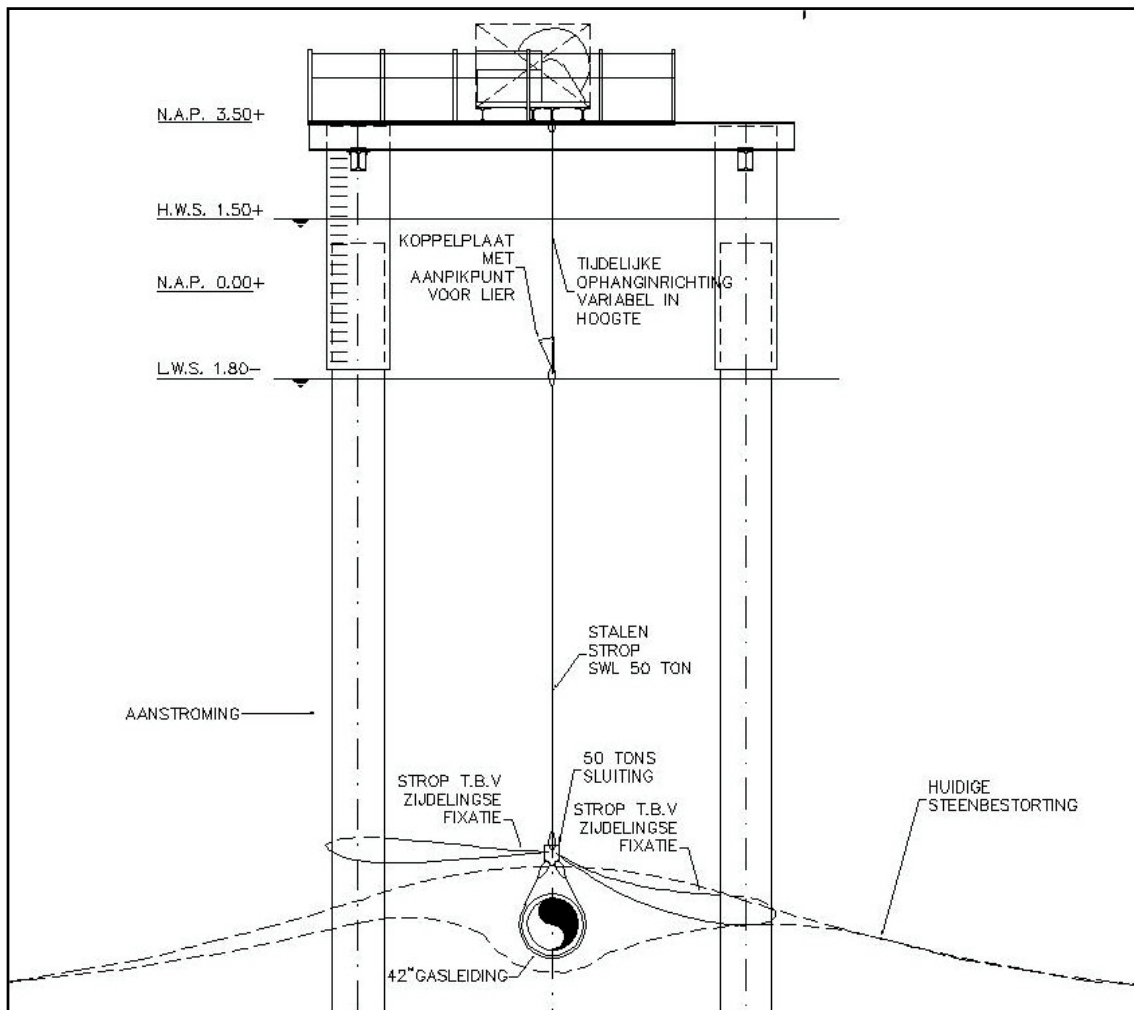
Ansicht Jochkonstruktion mit fixierter Gasleitung
